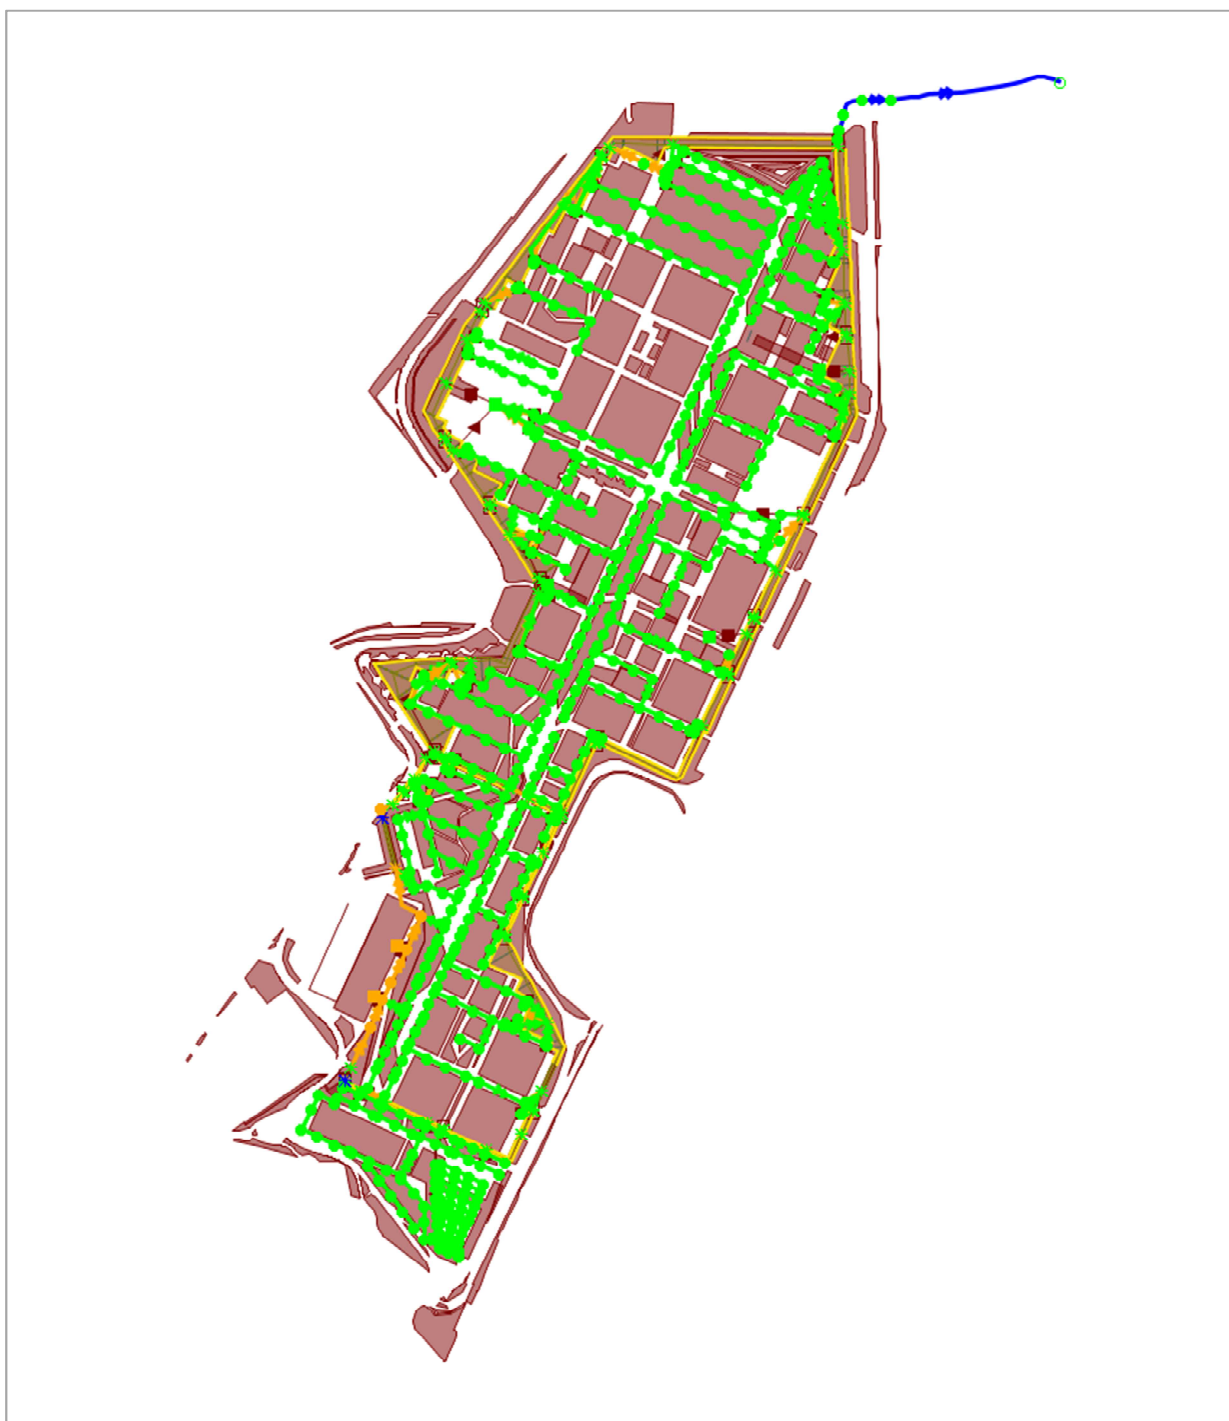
Planimetria di progetto rete acque bianche implementata in Infoworks.
